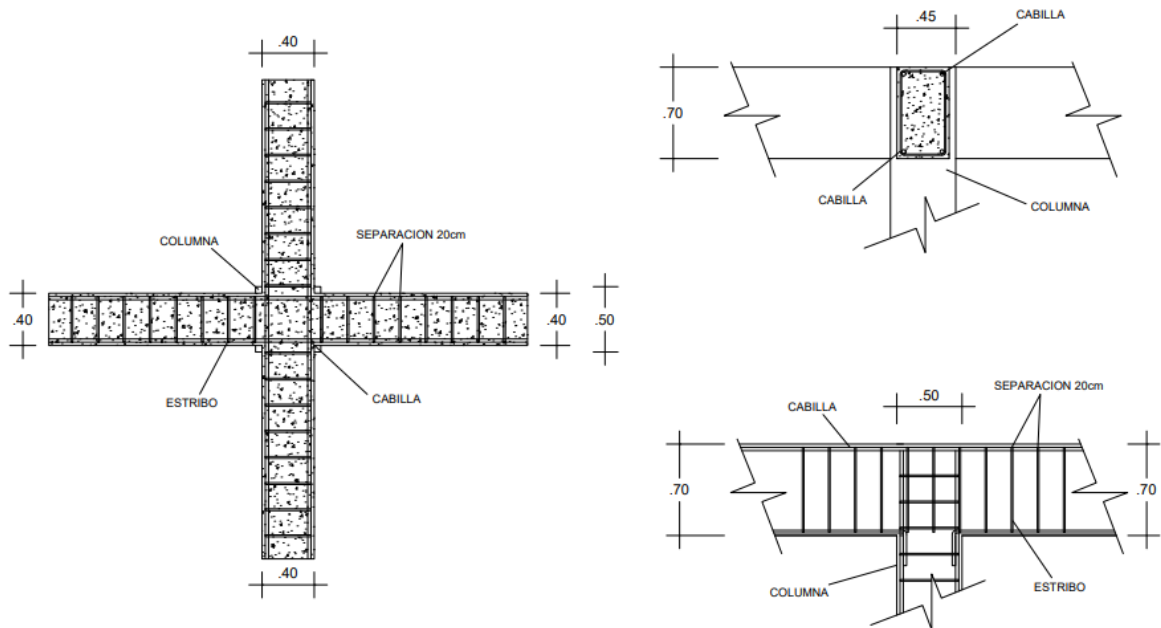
Detalle de Unión Viga Columna. (2018)
